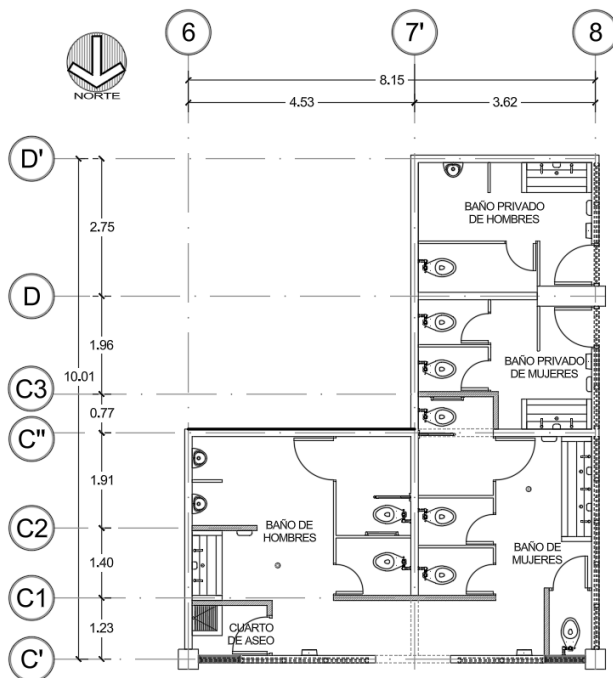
Planta Arquitectónica Módulos Sanitarios, Tercer Nivel
